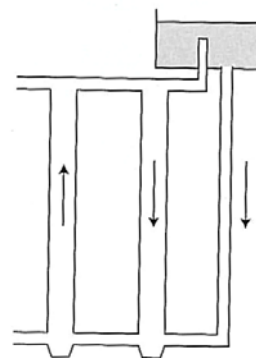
Circulação de água para arrefecimento da estrutura.
